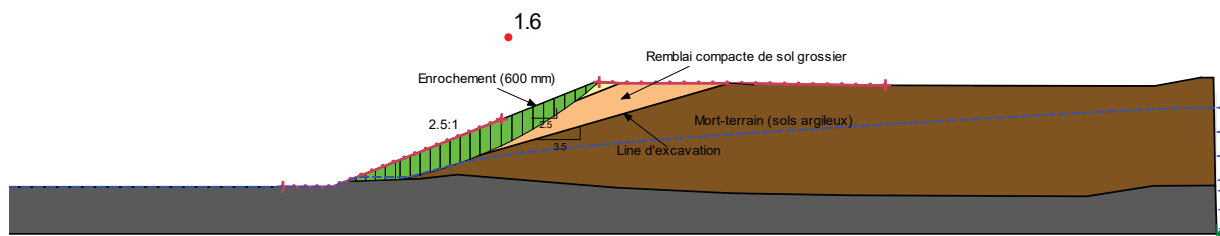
Stabilité long terme avec une couche d'enrochement de 600 mm, pente d'excavation 3,5H:1V et pente après le remblayage 2,5H:1V, excavation dans des sols argileux
